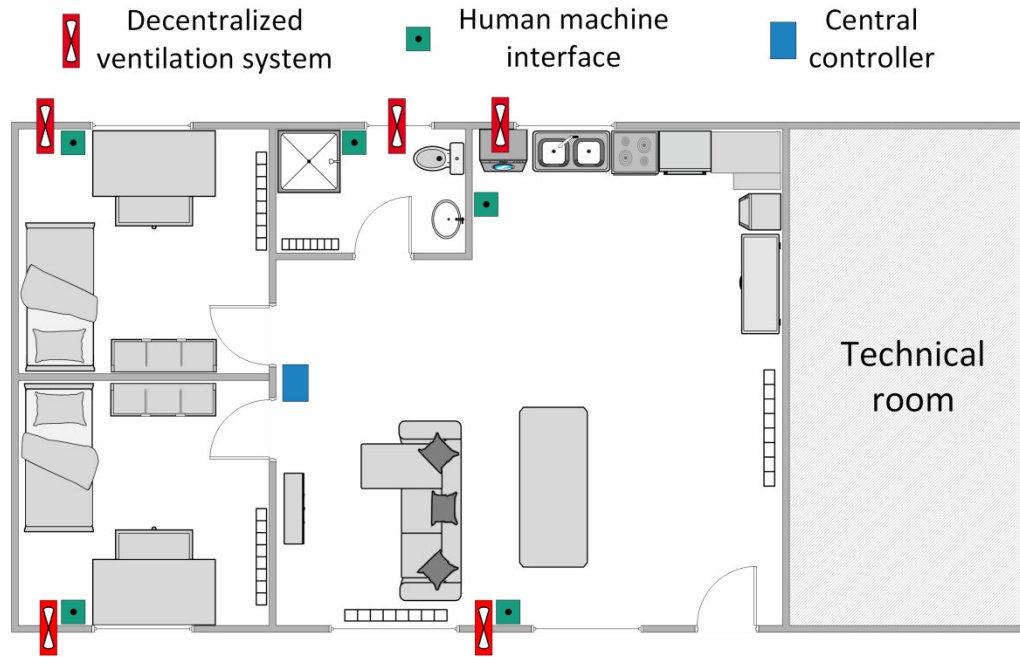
Grundriss des ESHL und Platzierung der Pendellüfter
